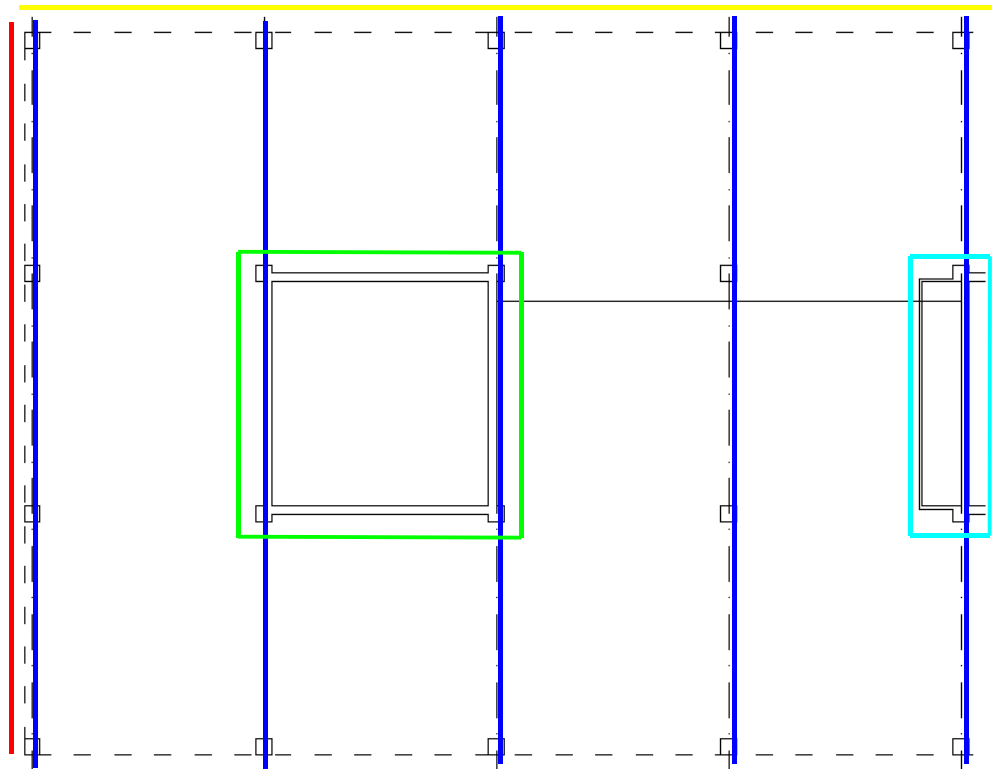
Plànol esquemàtic en planta de la zona del pàrquing. Font: pròpia (any 2014)
